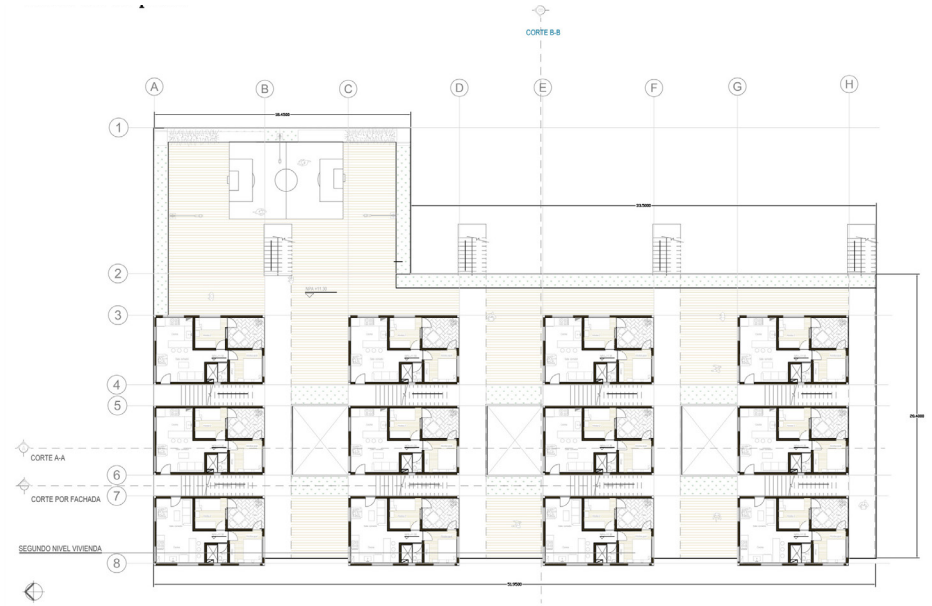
Planta de tercer piso/ *Fourth ground floor
